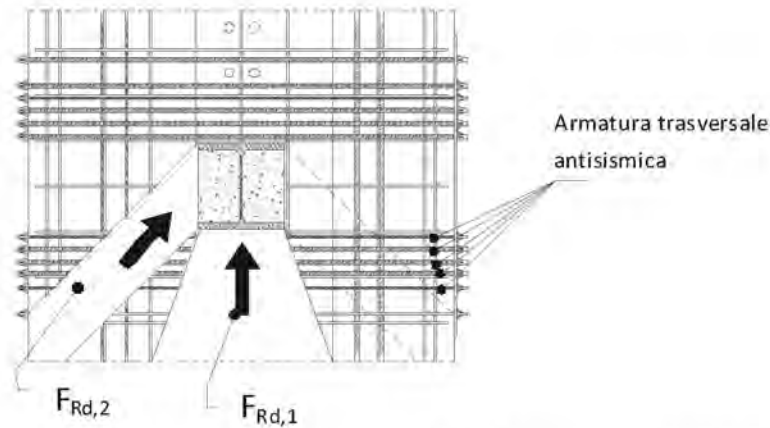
Vista in pianta dei meccanismi resistenti attivabili nella soletta compressa (momento positivo)
